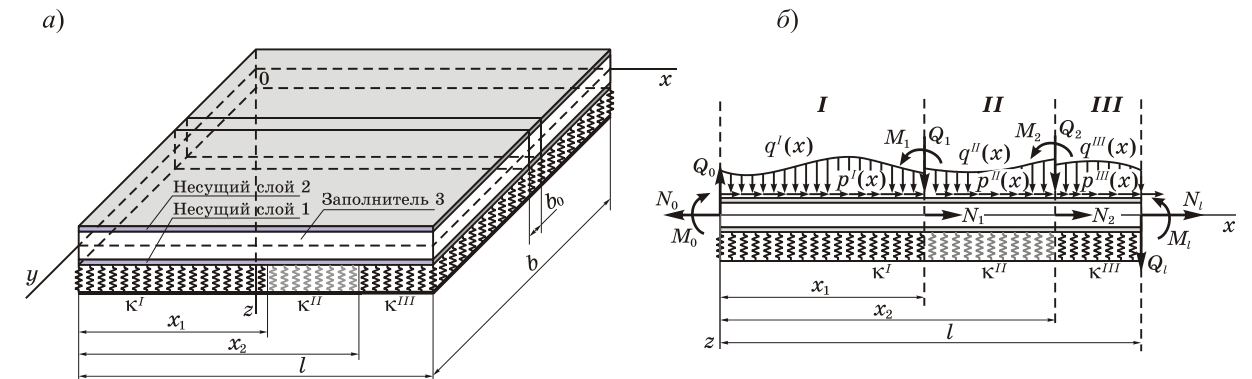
Расчетная схема прямоугольной трехслойной панели
